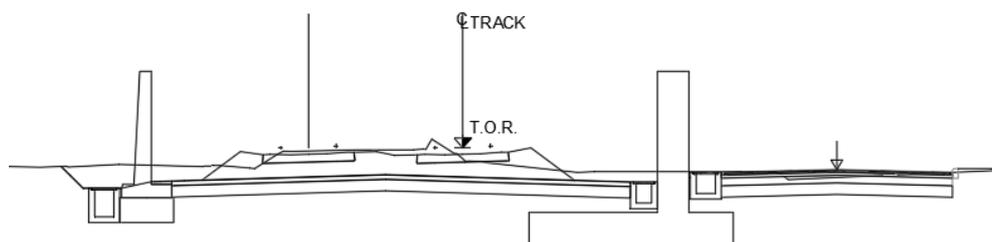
Sezione tipo situazione di progetto Via Erasmo Piaggio
